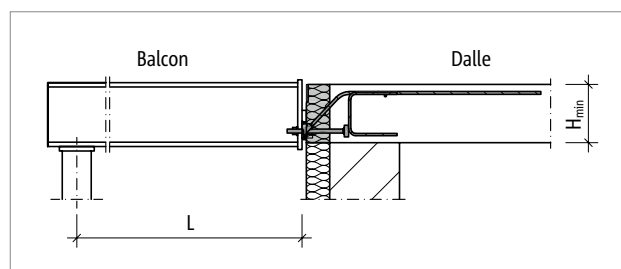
Schöck Isokorb® T type SQ : Système statique
